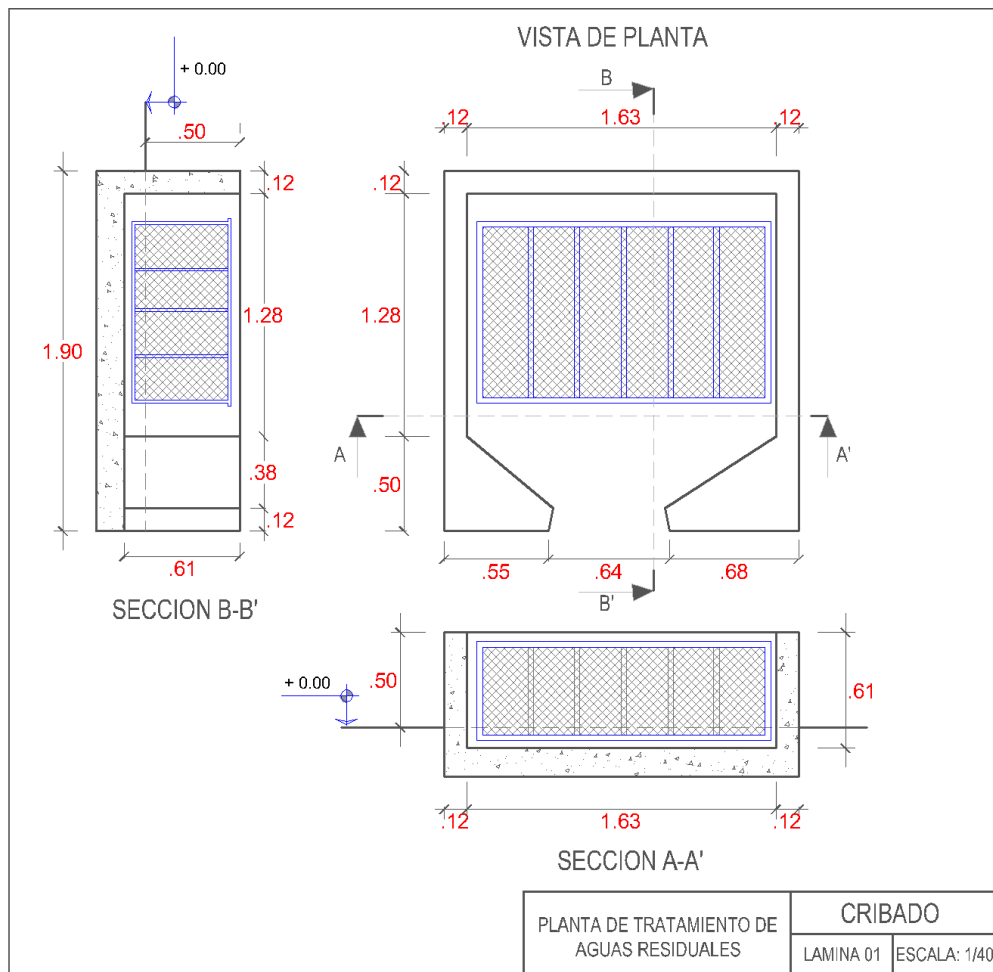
Vistas de planta, sección A-A' y sección B-B' del Cribado
